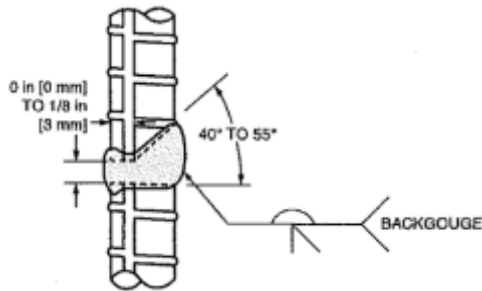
Unión directa a tope, posición 3G (vertical), con soldadura de ranura de bisel simple
